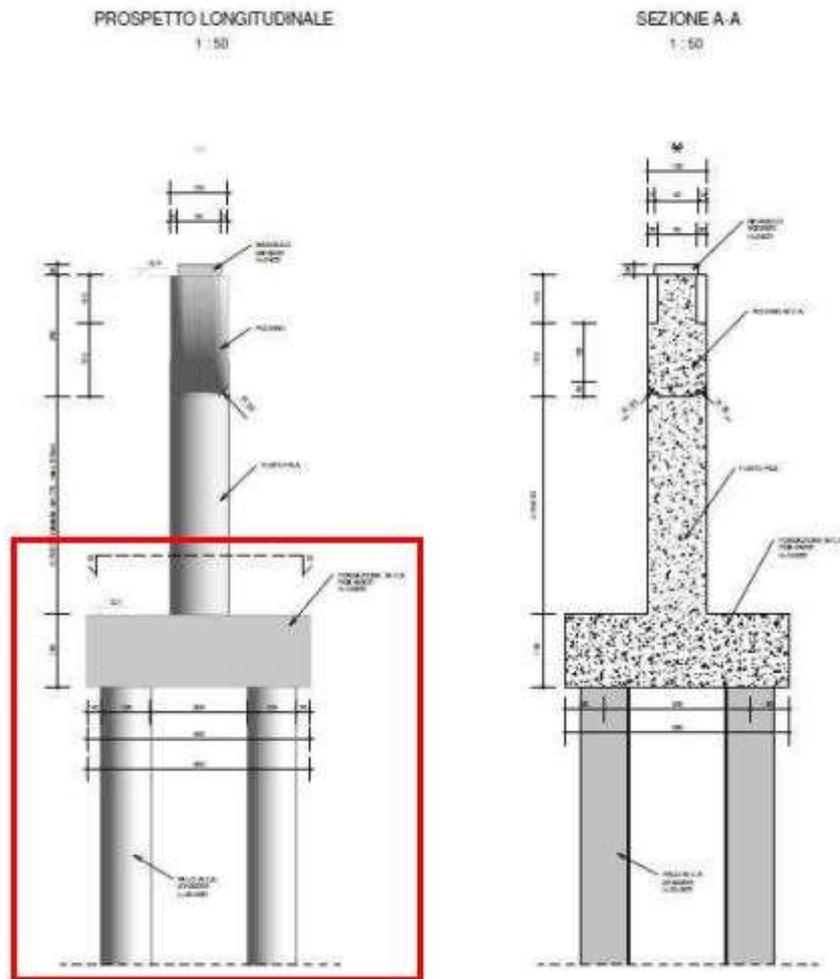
Pile (tipo)- prospetto, sezione e dettaglio fondamenta
